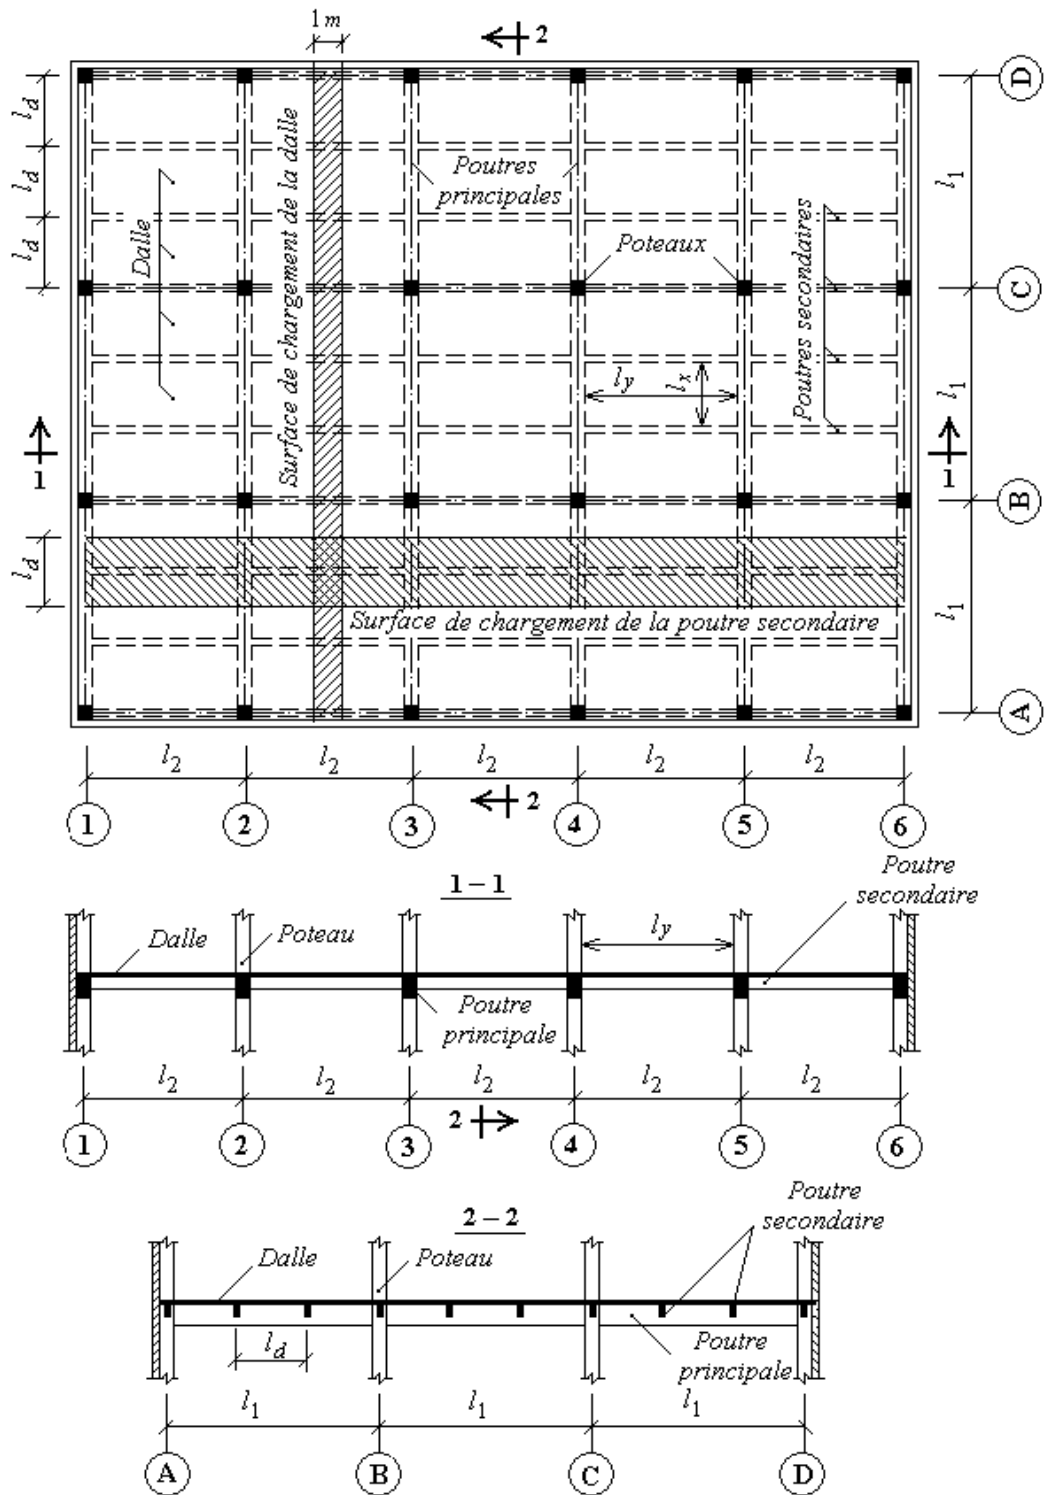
Plancher monolithe nervuré à lalles à poutres
